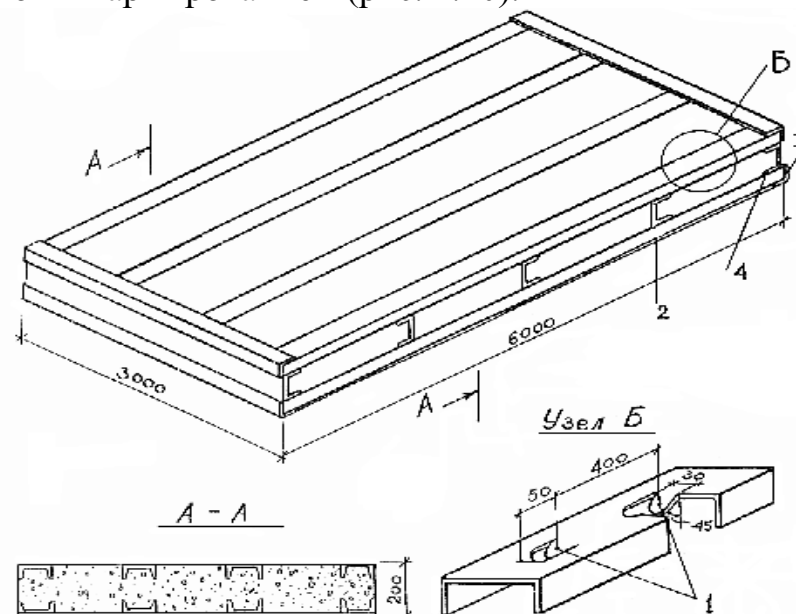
Конструкция легкобетонной плиты с внешним армированием:
